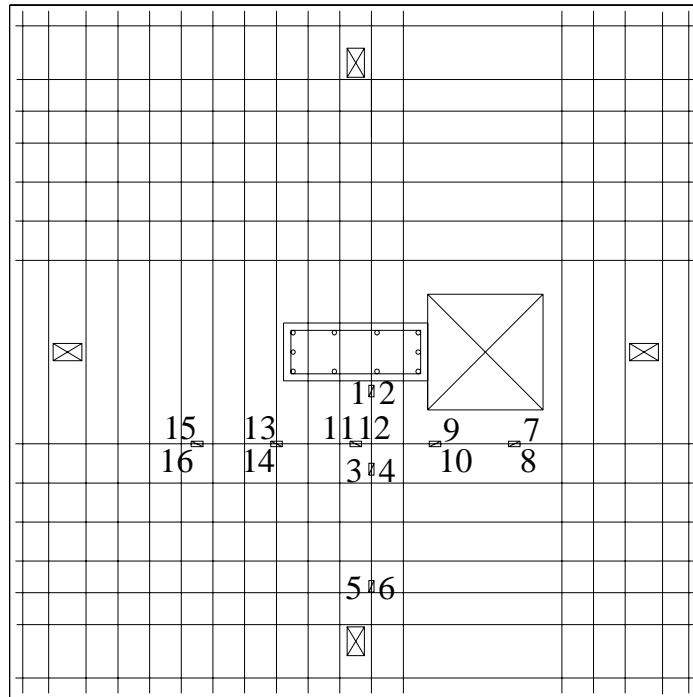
Posicionamento dos extensômetros da laje L4
